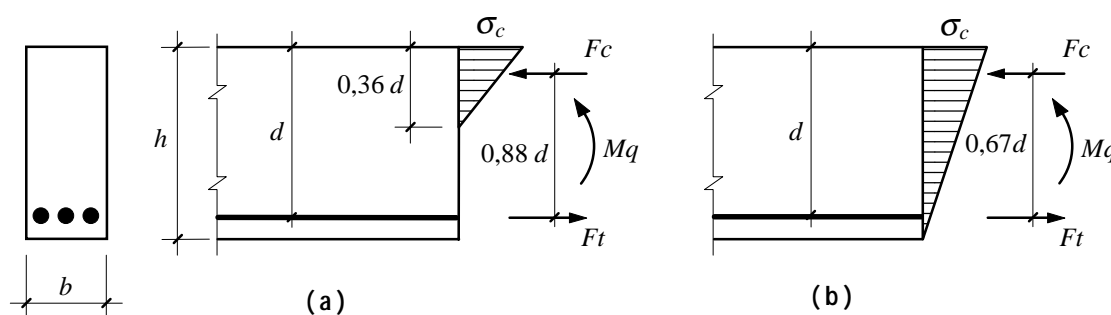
Exemplo de uma seção fletida, com armadura convencional (a) e com armadura protendida (b). Para a mesma tensão de bordo (σ_c) a viga protendida apresenta uma resistência em serviço aproximadamente igual ao dobro da viga de concreto armado.
